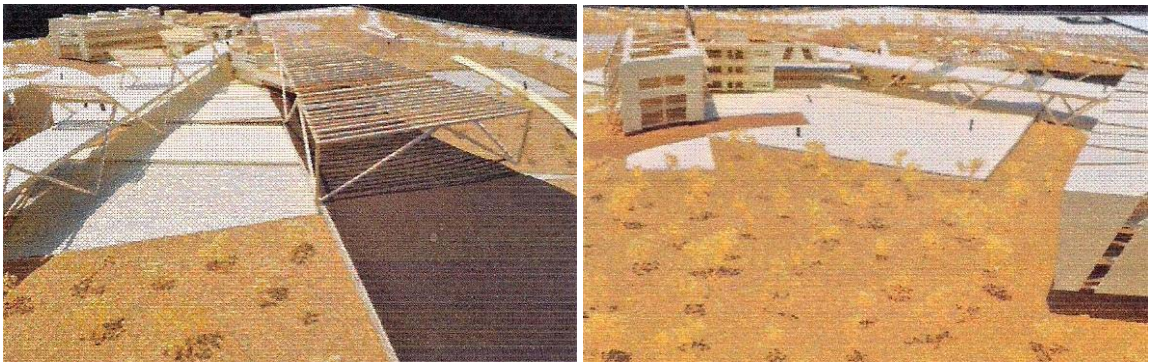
Vista de la zona de recreación en la planta baja del C.C.R
